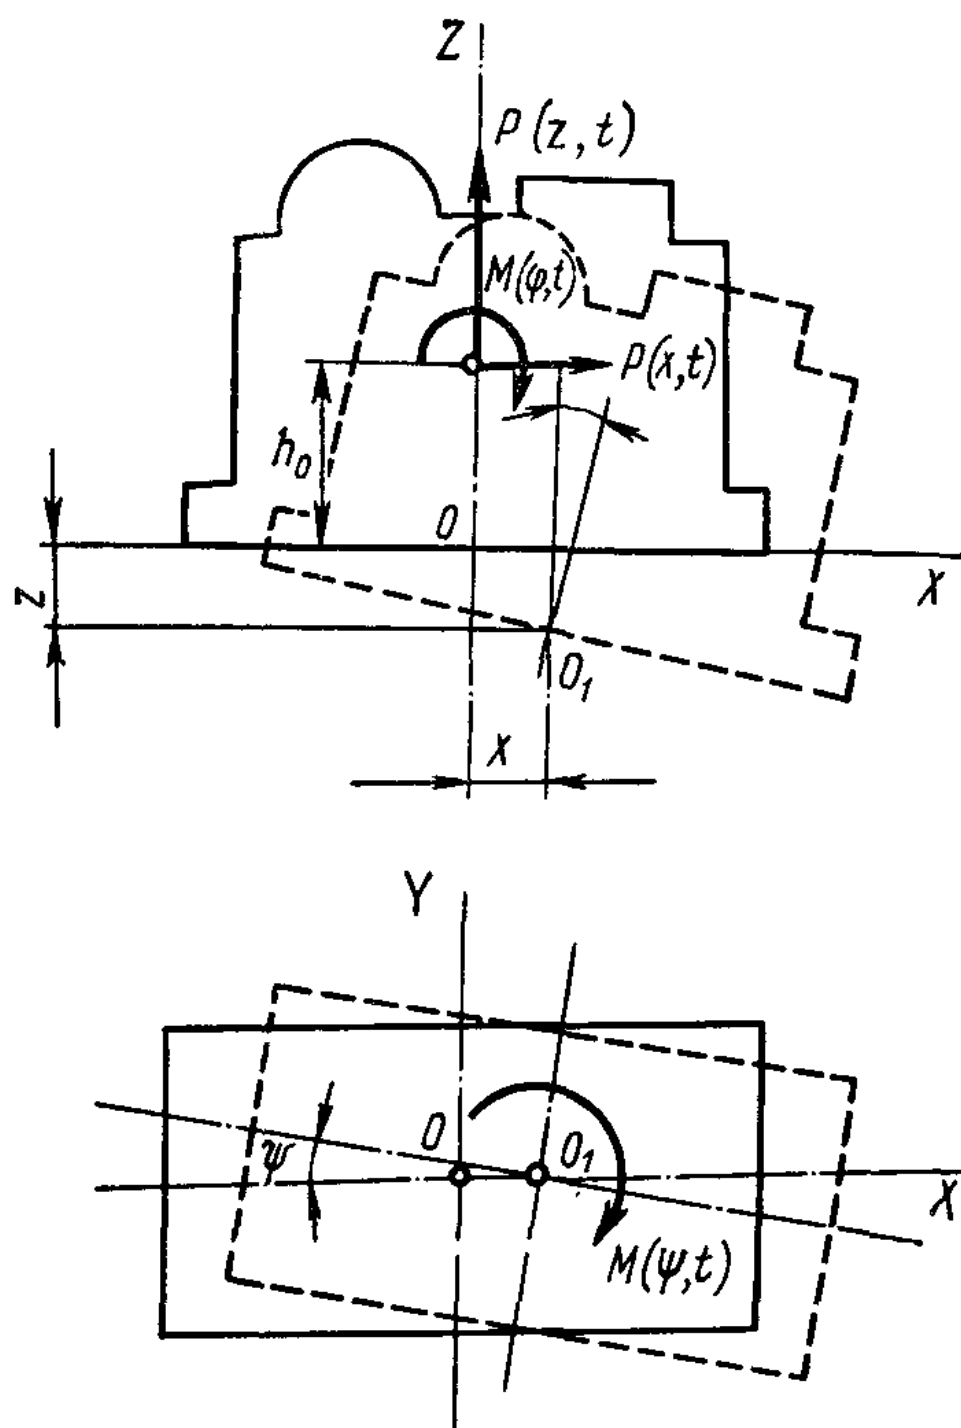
Схема внешних воздействий при расчете фундамента на колебания
